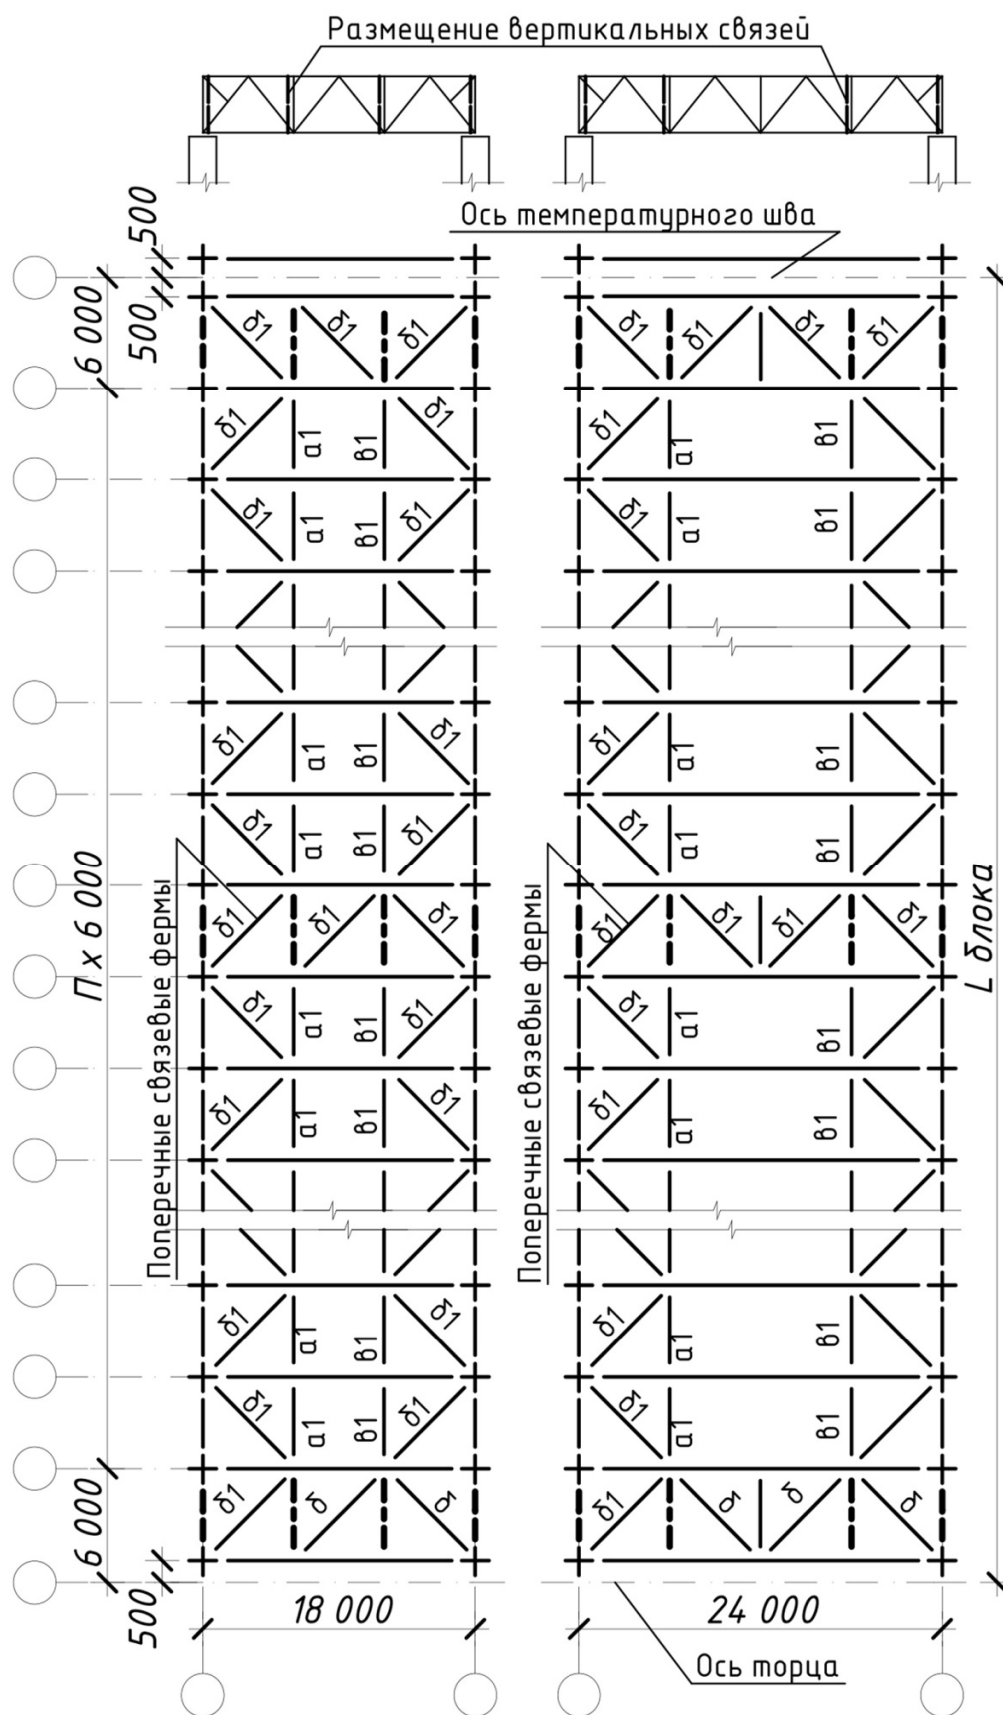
Схемы расположения связей I-го типа по нижним поясам стропильны ферм, шаг ферм 6 м, пролет 18 -24 м.
